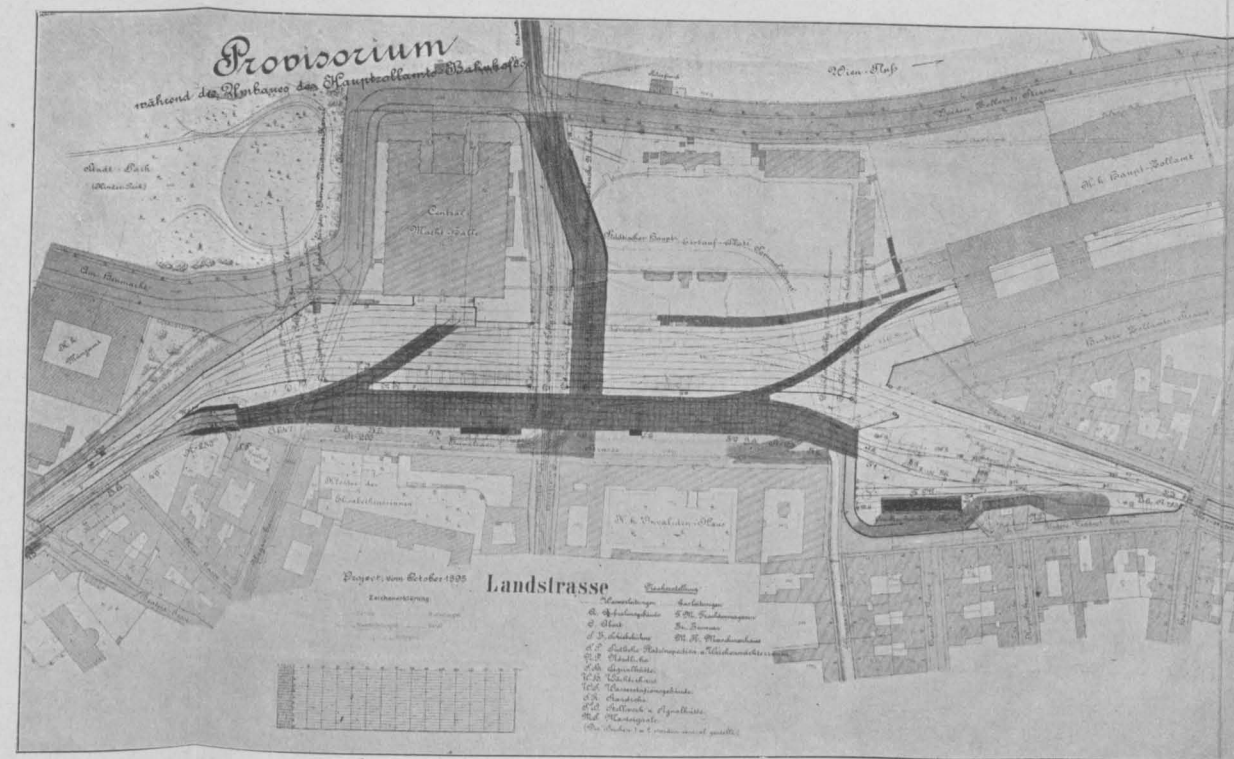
Lageplan des Provisoriums während des Baues. 1:5000.
